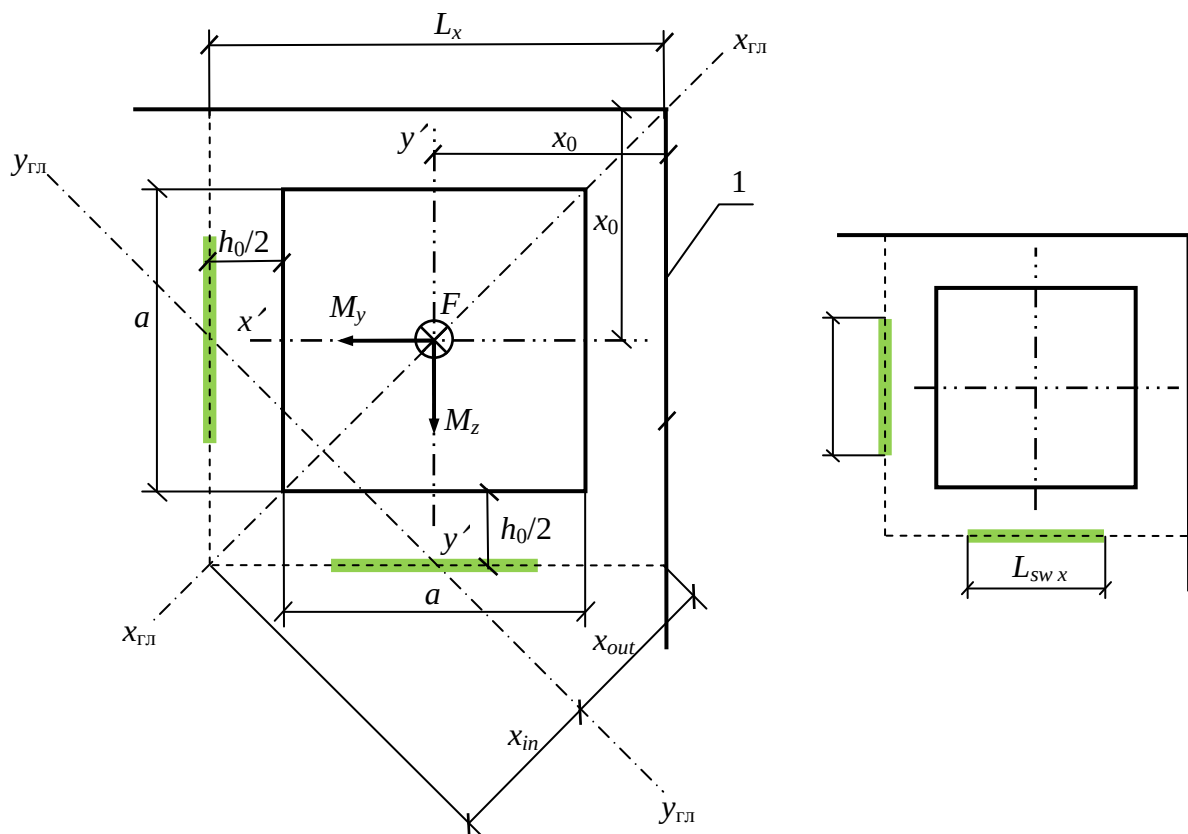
Сечение колонны и расчетный контур продавливания на углу плиты перекрытия.
